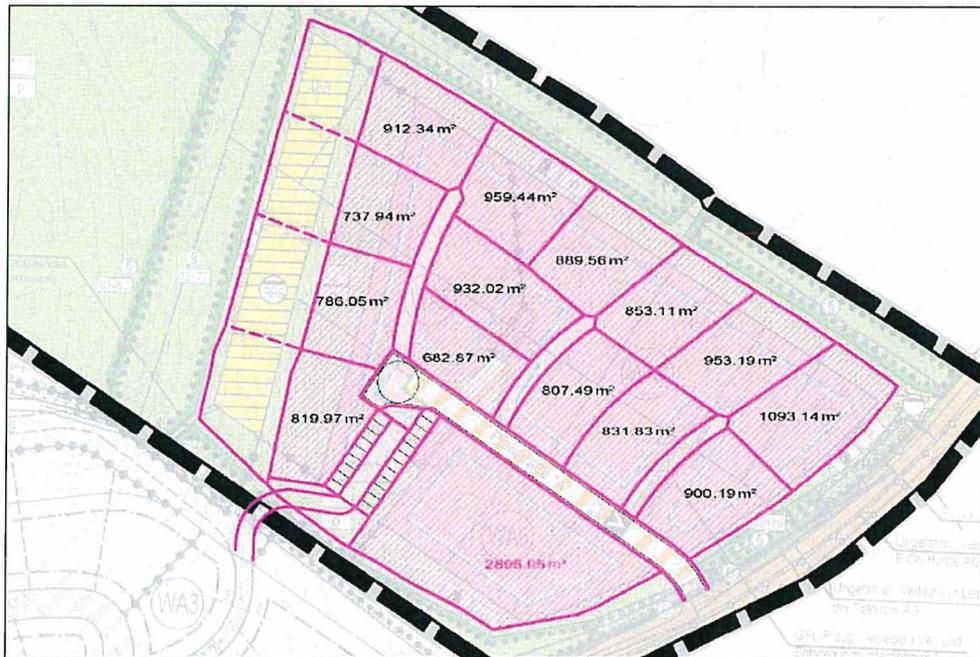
Städtebauliches Konzept- Vorzugsvariante, Planungsbüro Mahnel November 2020
